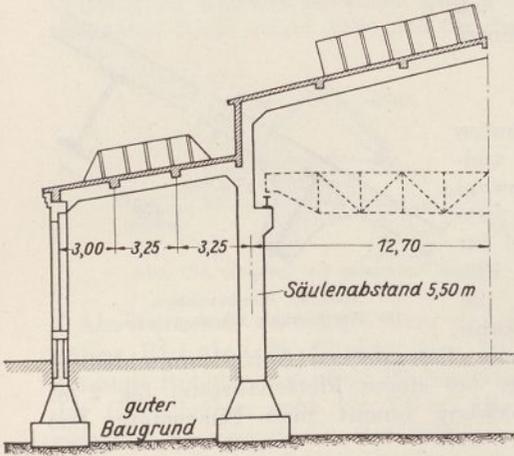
Flaches Eisenbetondach als Plattenbalkendecke.
